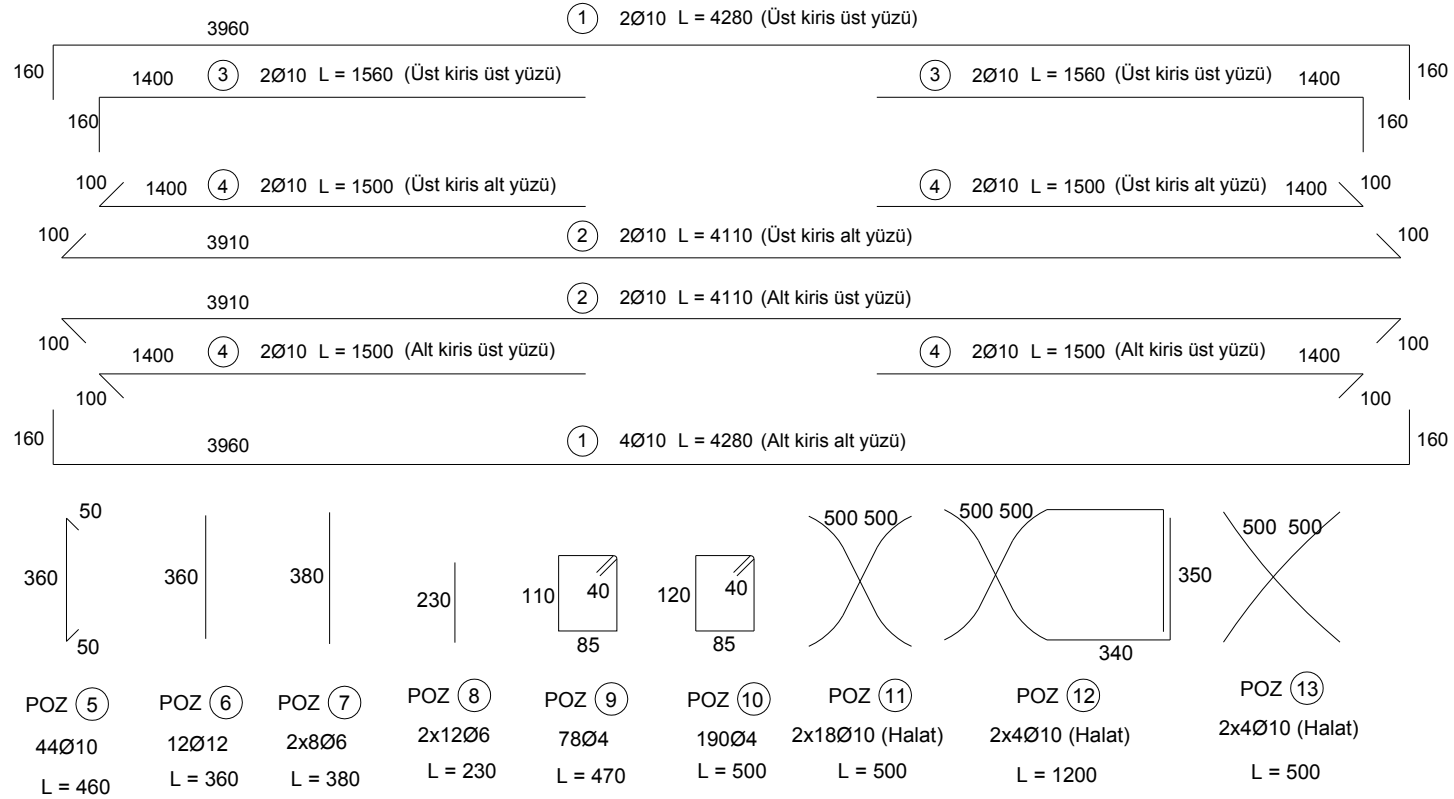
RRxn kiriş donatı planı ve kesitleri
